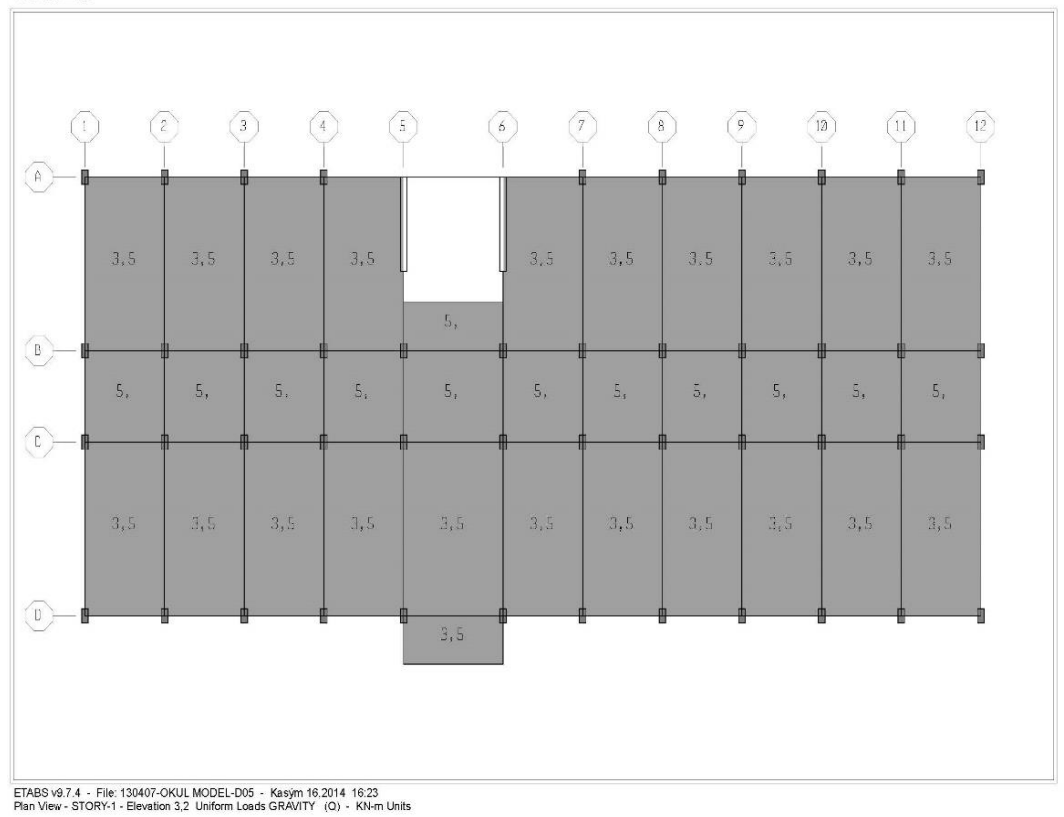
Tipik bir plan üzerinde “G2” yüklemesi.
